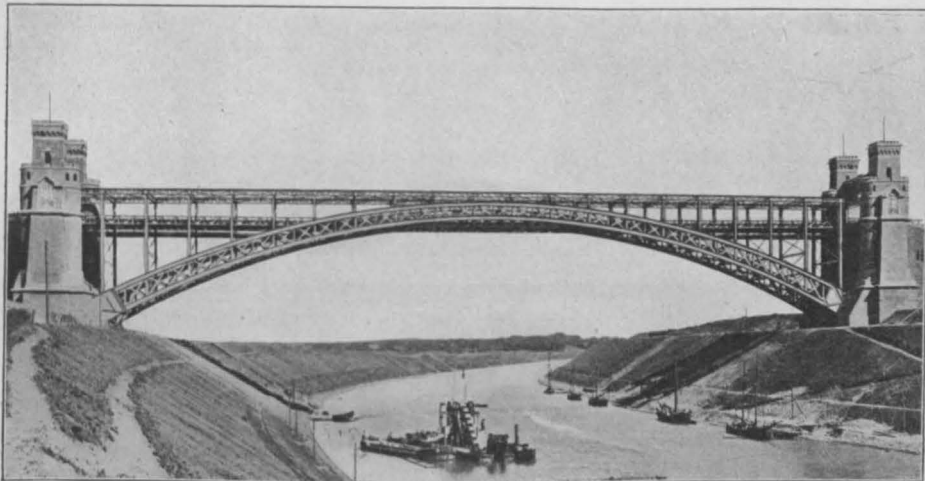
Straßen- und Eisenbahnbrücke über den Nordostseekanal bei Levensau.
